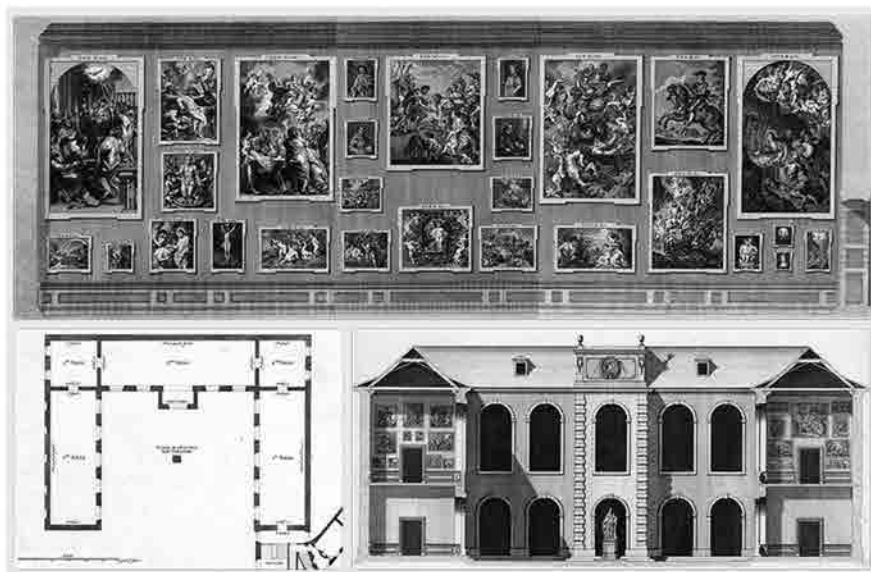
| *Galleria Elettorale*, Düsseldorf: sezione, pianta e prospetto interno della seconda sala (dipinti di P. Strudel, A. Van Dyck, B. Flemael, H. van Acken, G. de Lairese, D. Vinckboons, A. Schoonjans), da De Pigage, von Mechel, *Galerie Électorale*, 1778.
